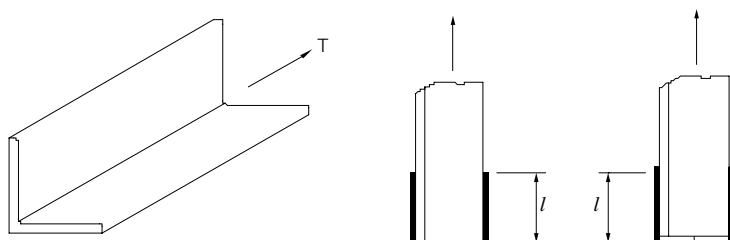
Determinación de l para U para conexiones con soldadura longitudinal y transversal.
